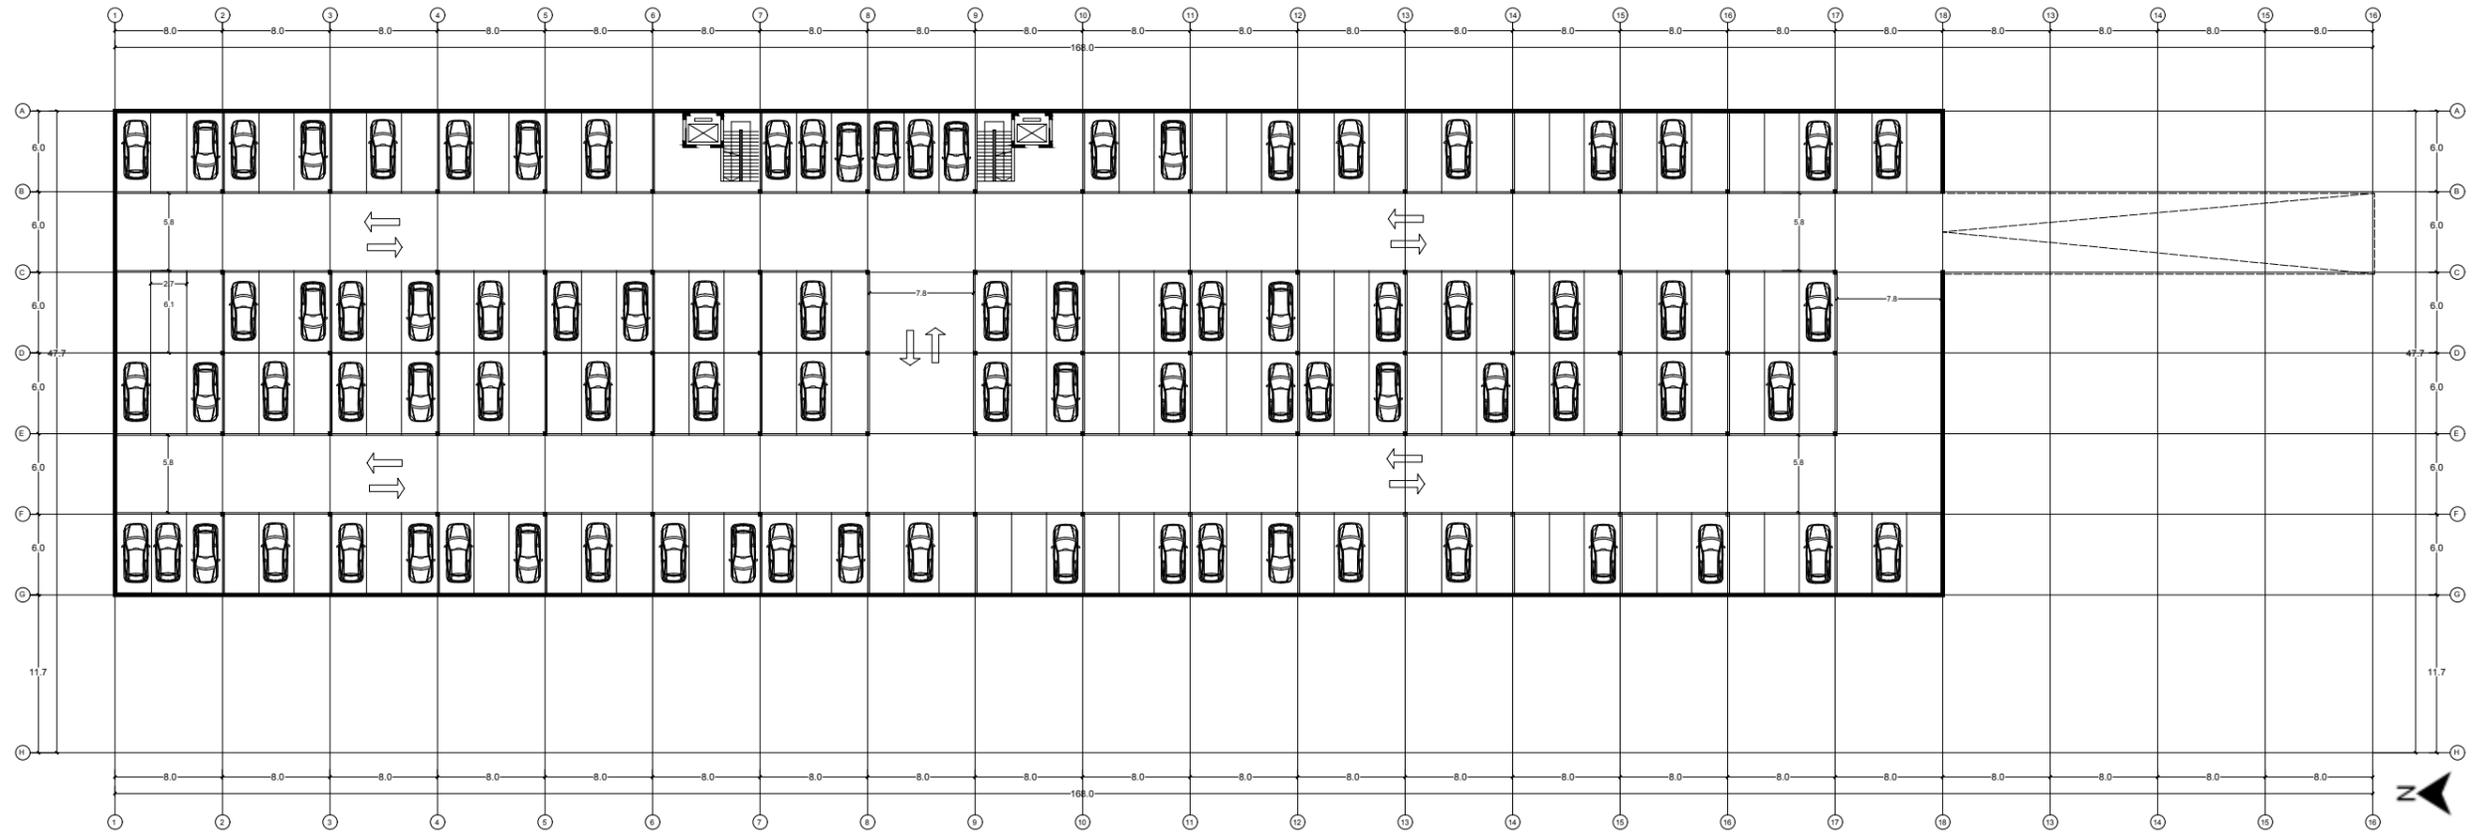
y 67: Planos intervención Polígono 2. Fuente: Elaboración propia
